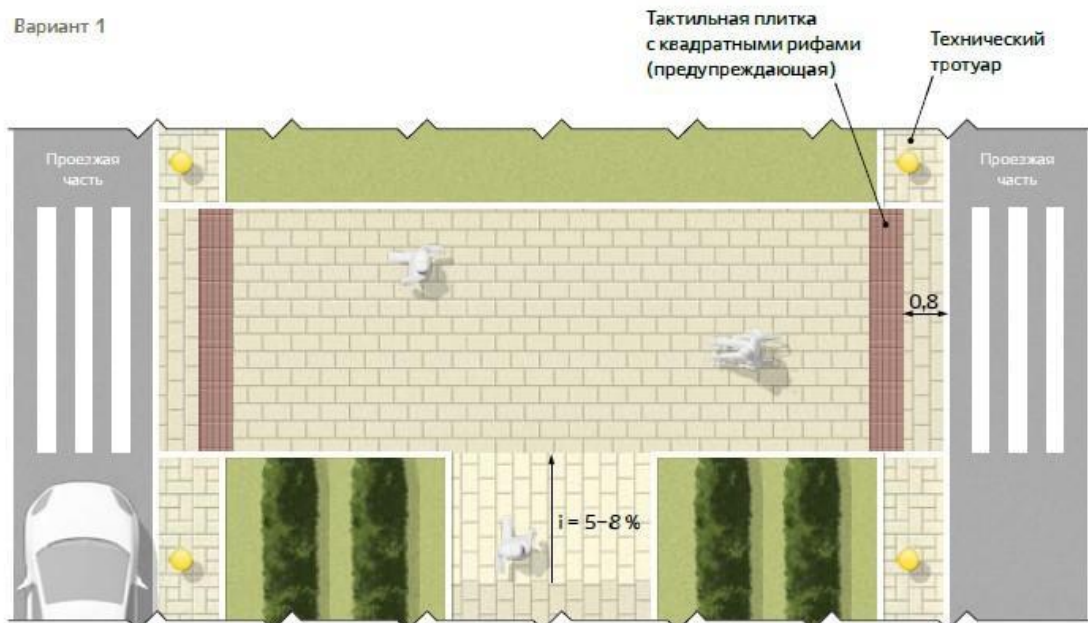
Размещение тактильных плит на пешеходных тротуарах, расположенных на уровне проезжей части (вариант 1,2)
